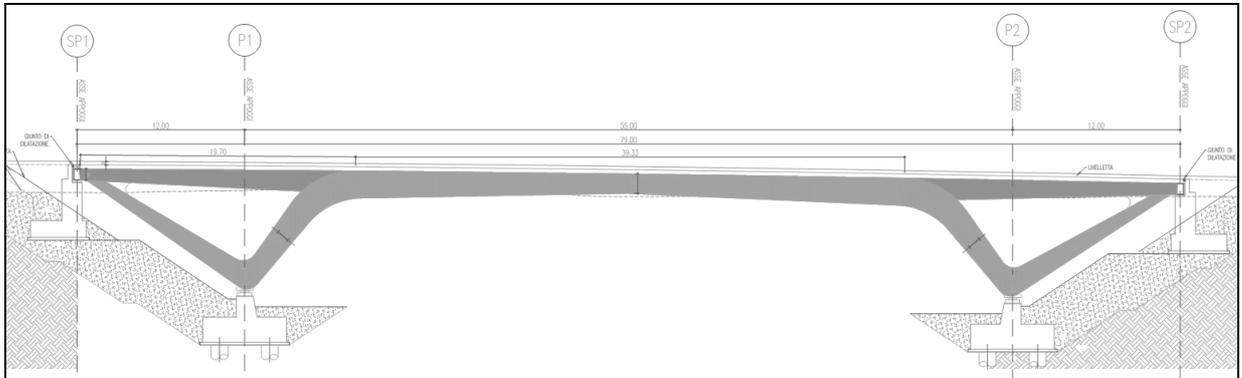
Sezione longitudinale cavalcavia per le strade ANAS
